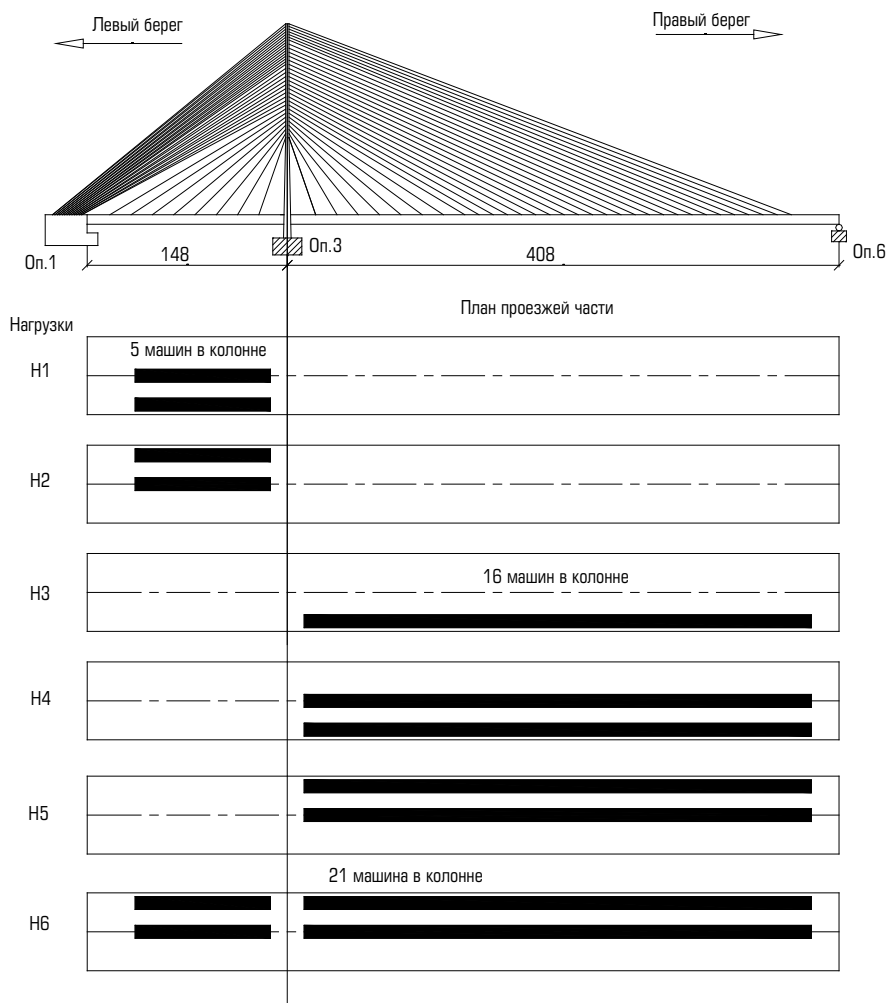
Схема расположения испытательной нагрузки на вантовом пролетном строении в плане
